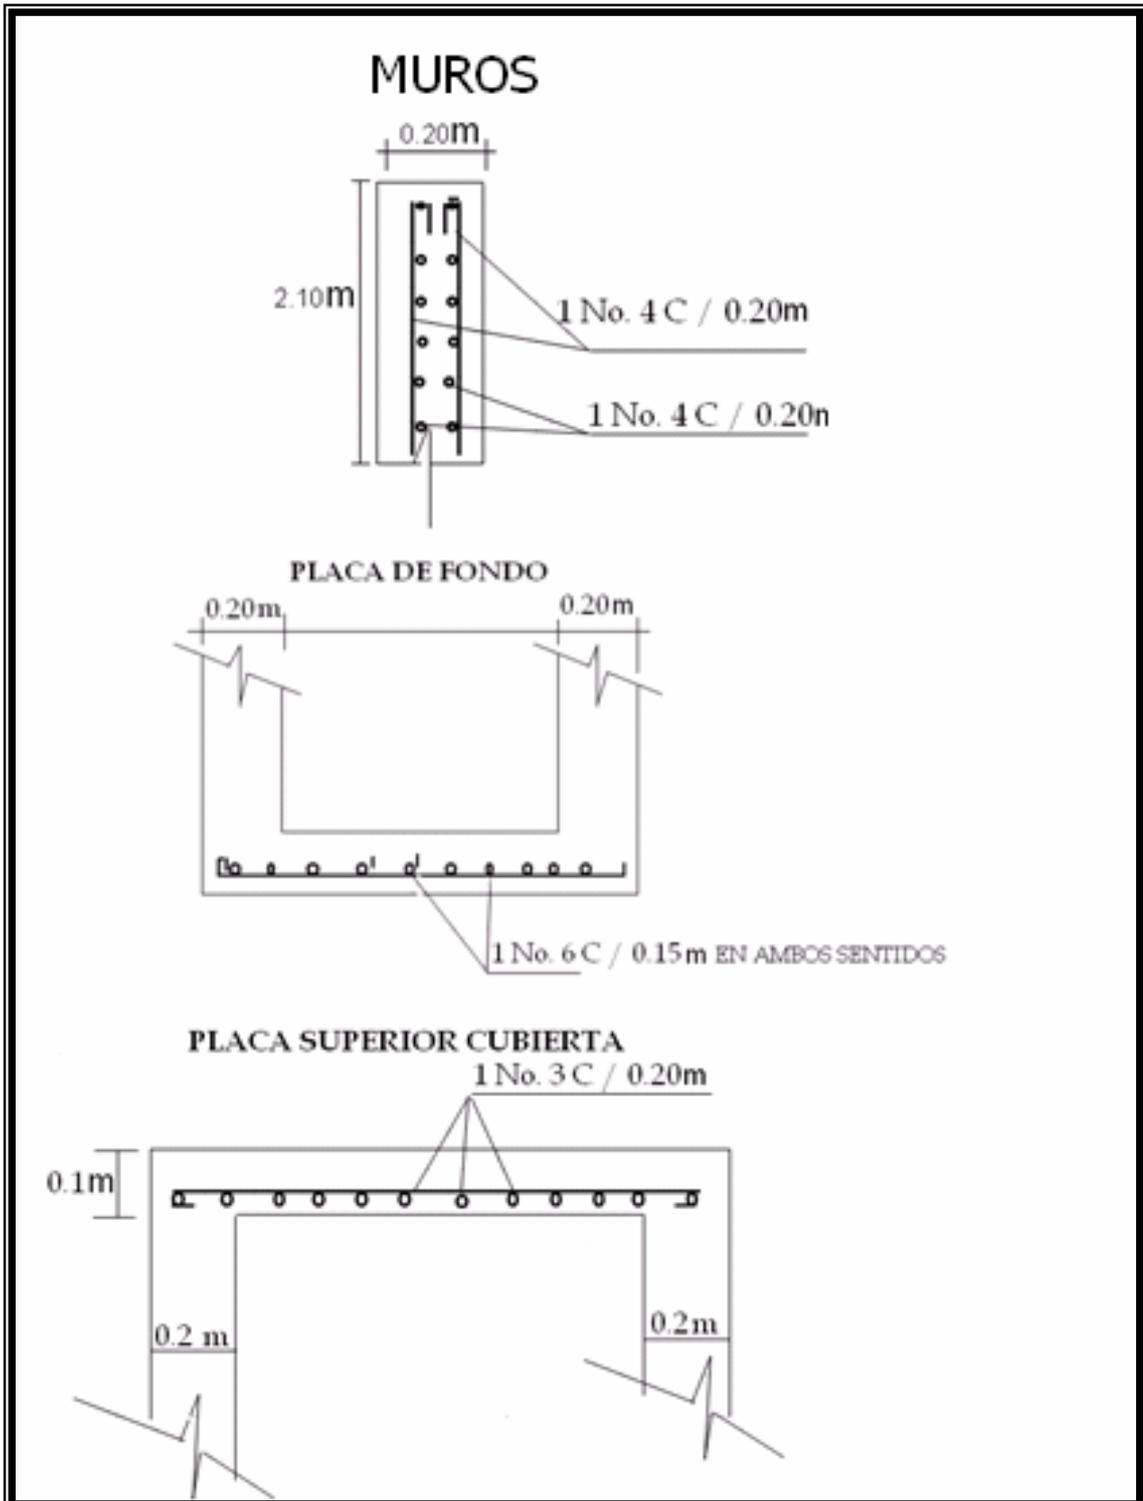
Aceros de los muros, placa de fondo y Cubierta – Tanque de almacenamiento
